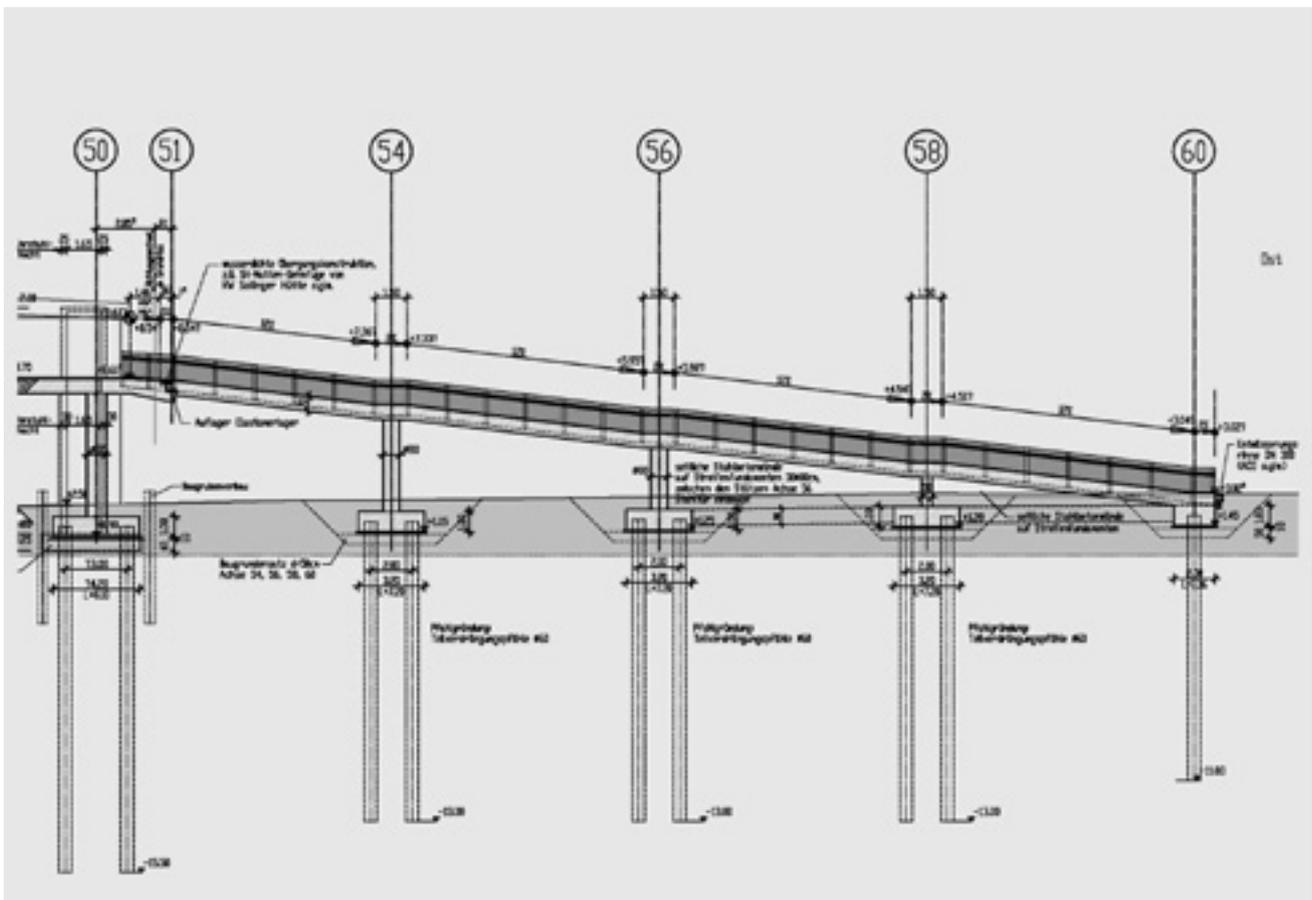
Stahlbetonrampe zur Bahnhofspassage
